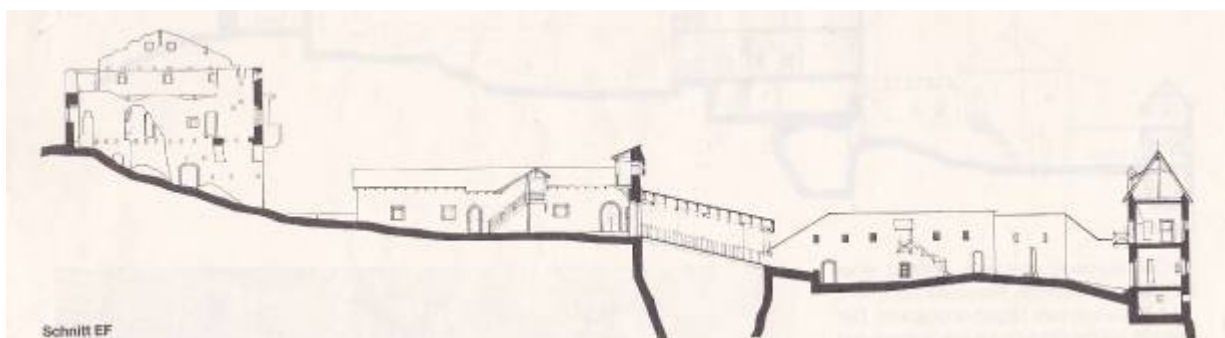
und 259: Grundriss und Schnitt Schloss Juvals.
